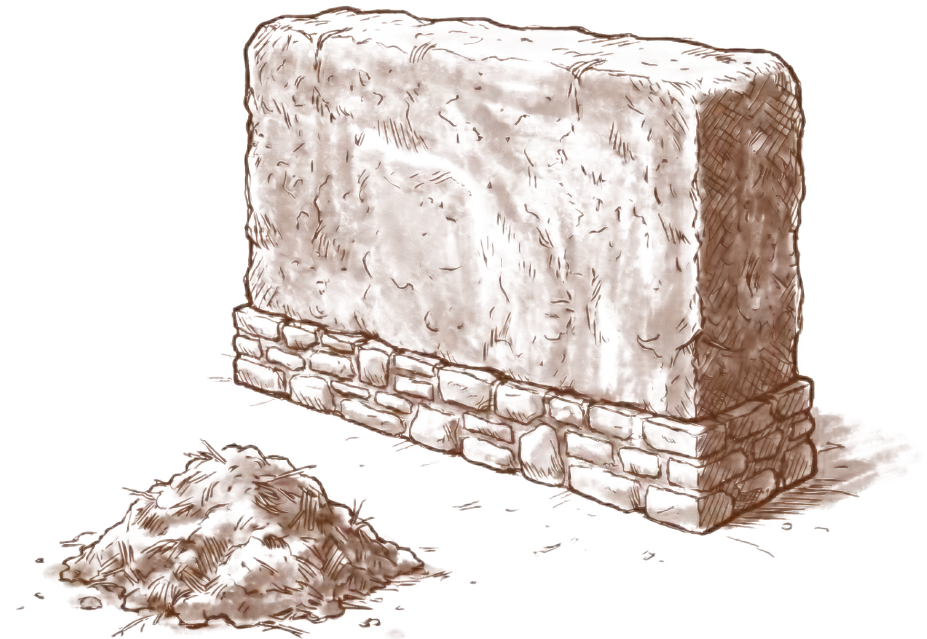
Croquis d'un mur en bauge soutenu par un mur de soubassement en pierre
